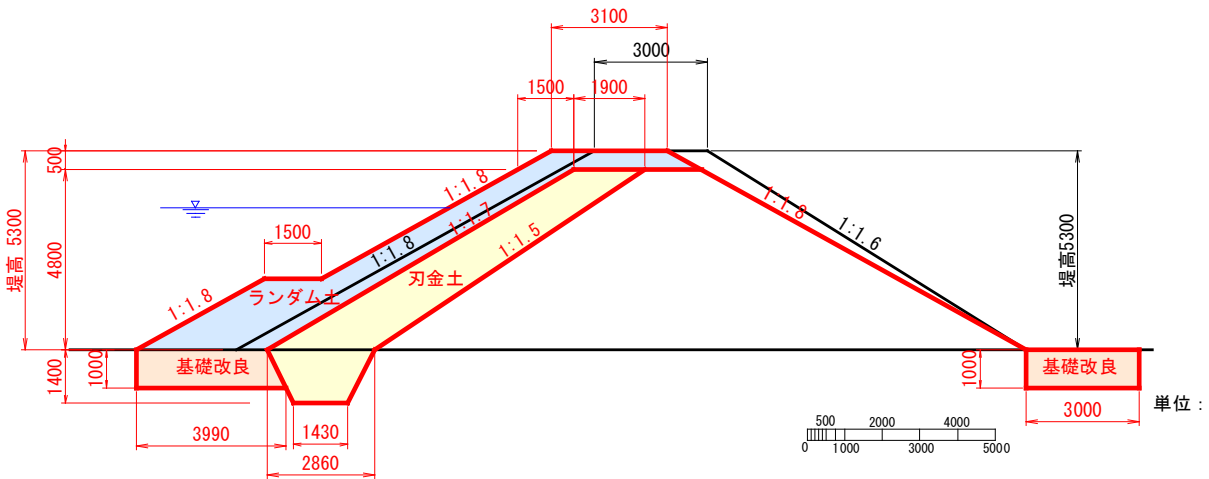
施工コスト算定用計画堤体断面（基礎改良工法）-1（H=5.3 m）
